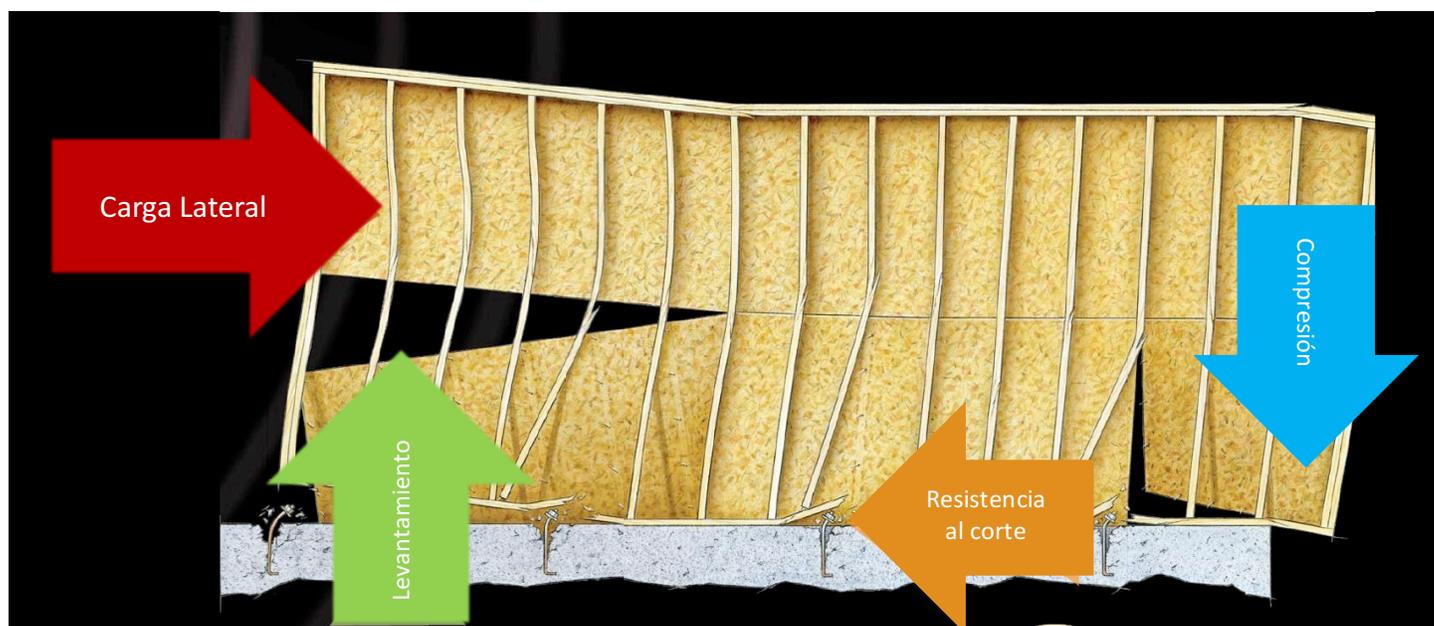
Muro de corte sometido a carga lateral con fallas. (Design of building components and systems fall, 2012).
